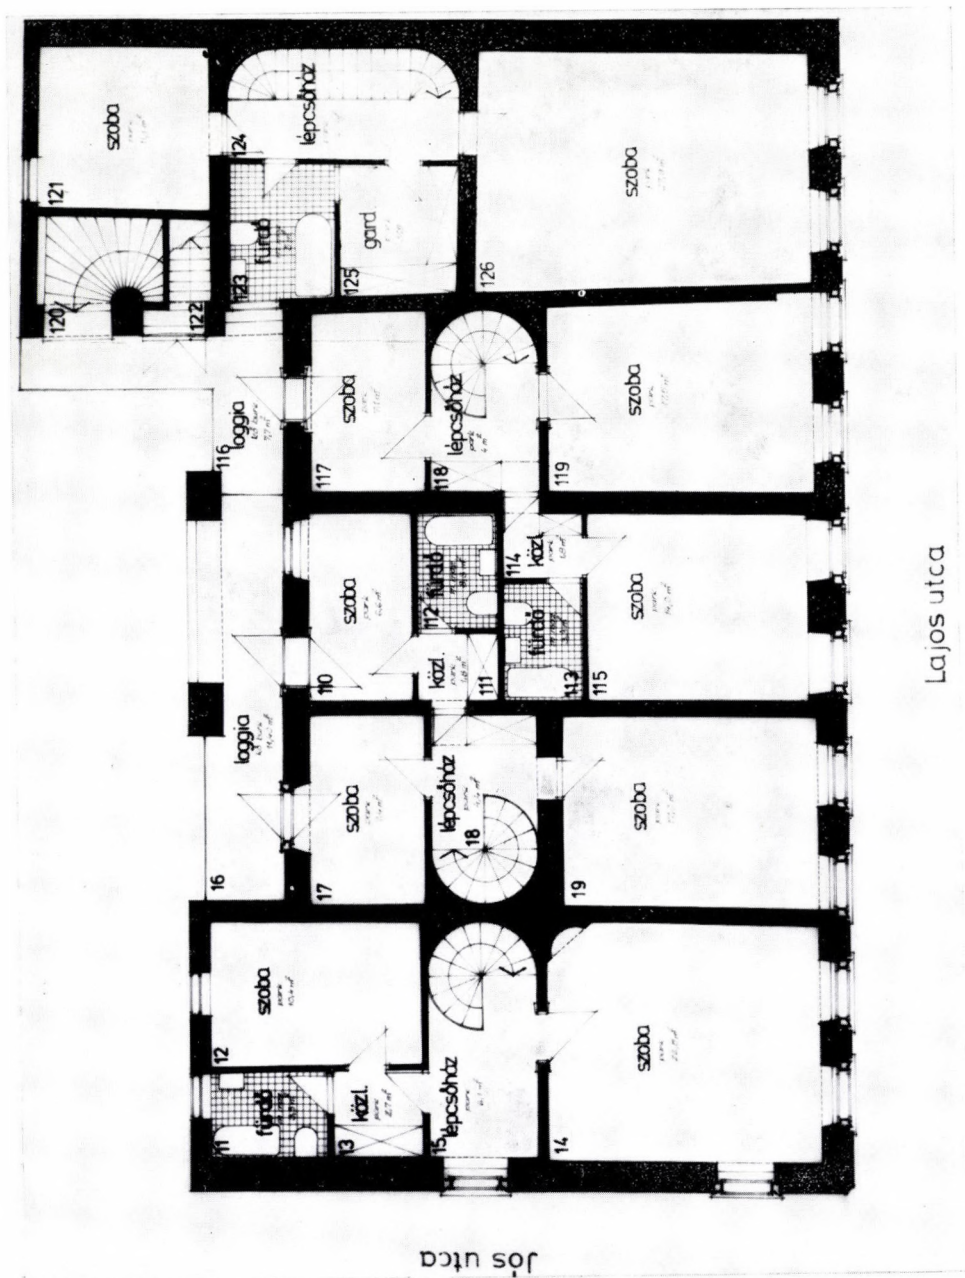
Lajos-Gasse Nr. 152 Restaurierungsplan, Grundriß des Stockwerkes
